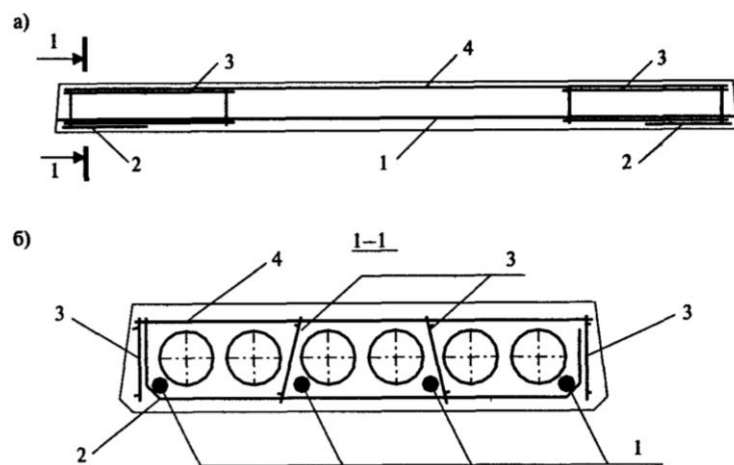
Армирование предварительно напряженной пустотной плиты перекрытия: а) продольный разрез плиты; б) поперечный разрез плиты; 1 — предварительно напряженная арматура; 2 — сетка, окружающая предварительно напряженную арматуру на участках передачи напряжения; 3 — каркасы; 4 — монтажная сетка
